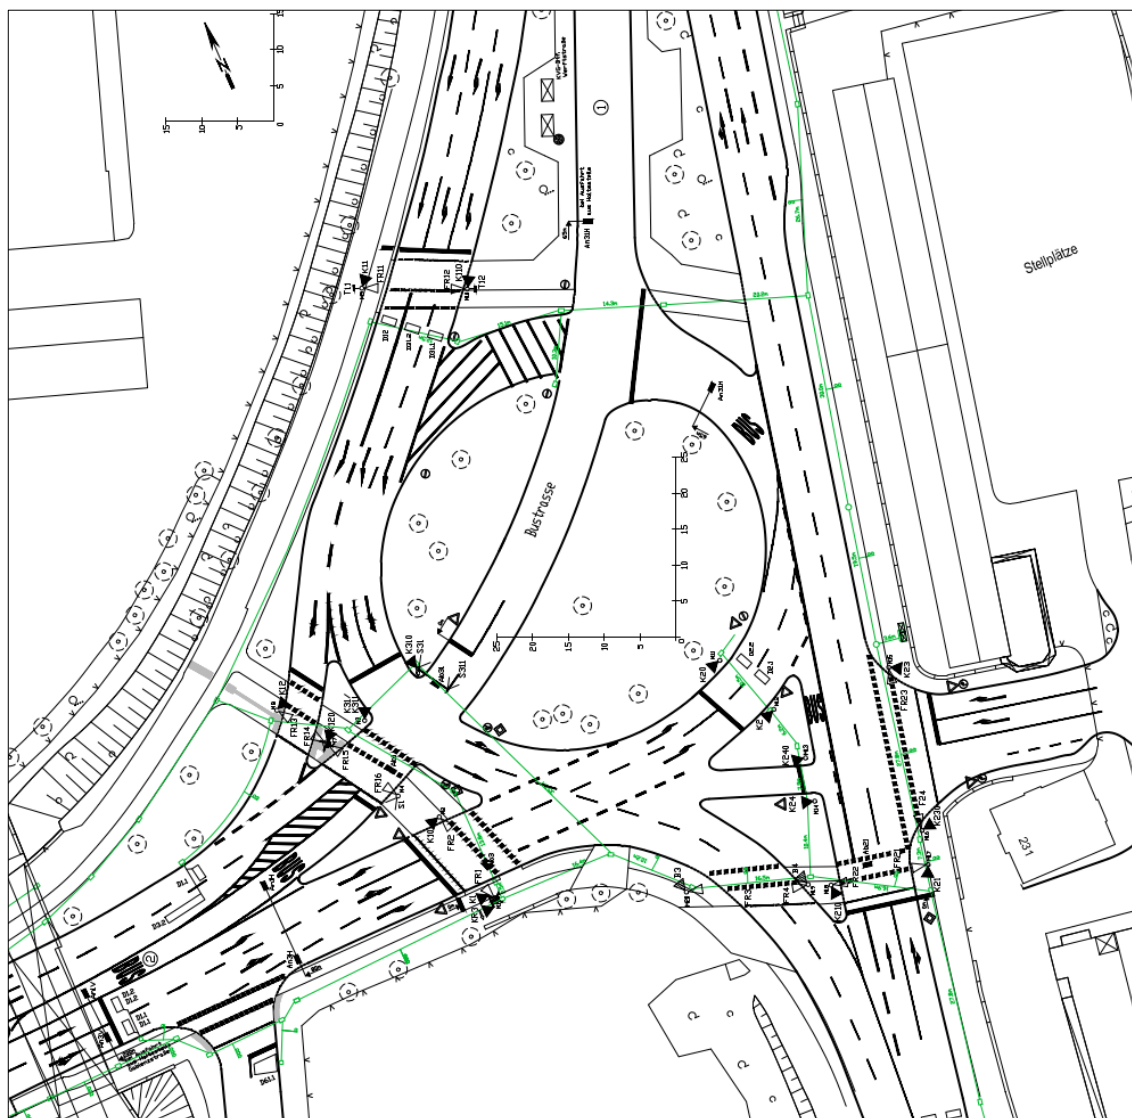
Knotenpunkt Werftstraße/Gablenzstraße – Signallageplan [15]
